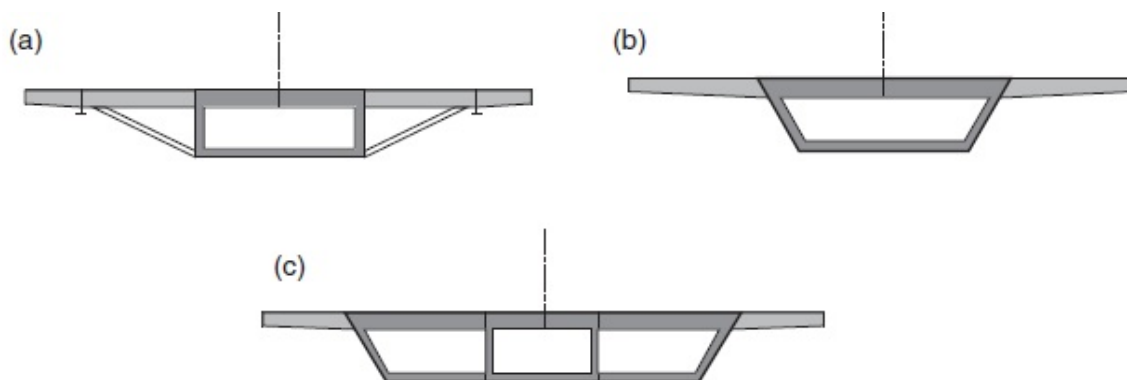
Secțiuni transversale pentru tabliere cu un singur plan central de cabluri
